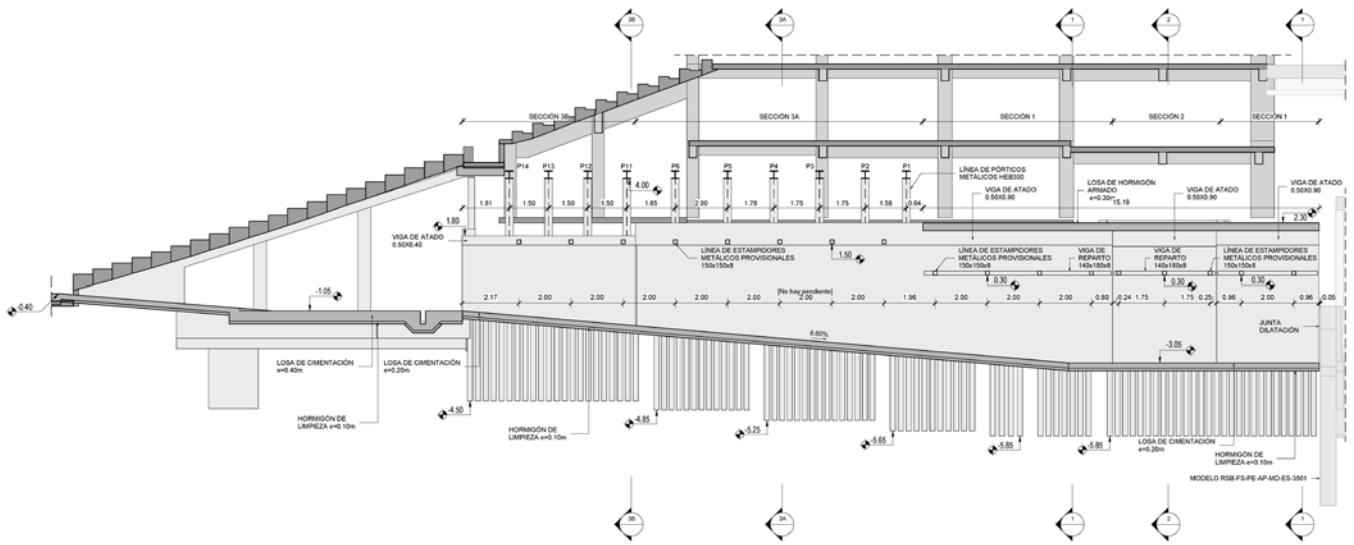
Sección longitudinal del túnel de carros. A la izquierda la salida al terreno de juego, a la derecha la conexión con aparcamiento. Procedente del proyecto de ejecución.
